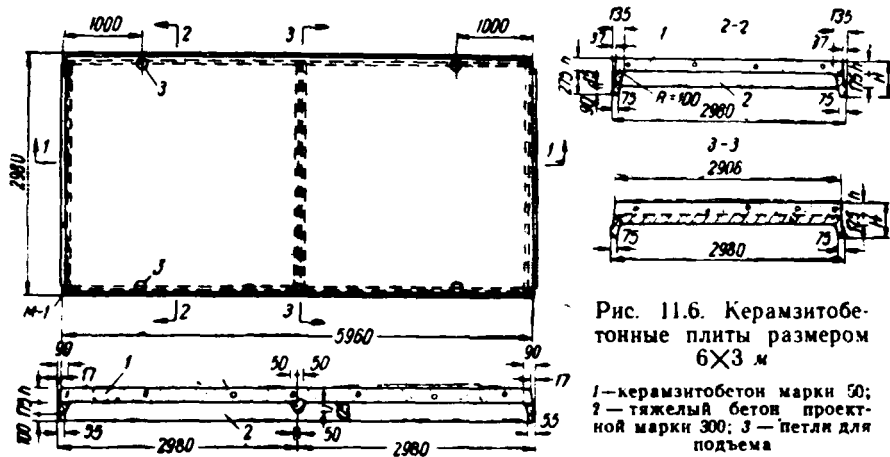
Керамзитобетонные плиты размером 6×3 м
